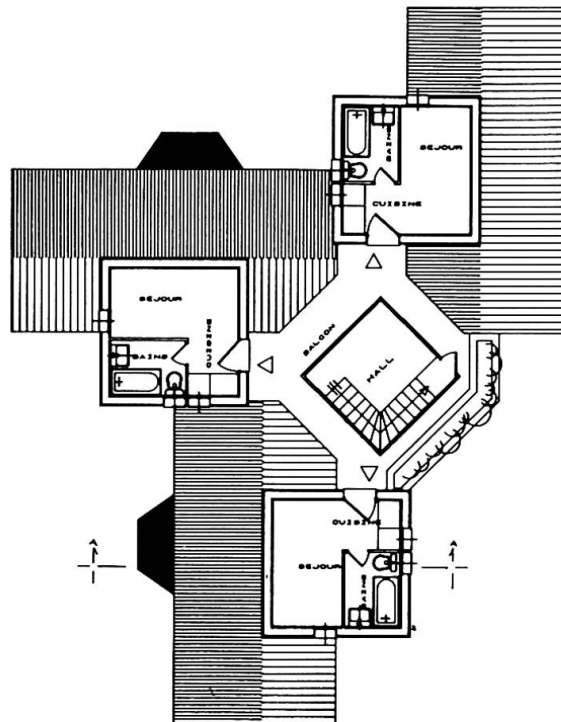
ARCADE – Vue en plan – Sortie sur traceur
